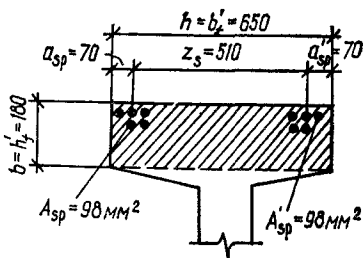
Расчетное сечение подкрановой балки при расчете на действие горизонтальных сил
